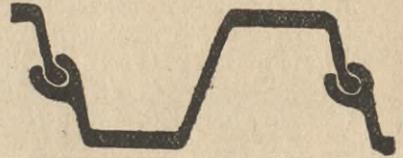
Rothe Erde-Spundwand. [Gelsenkirchener Bergwerks-Aktien-Gesellschaft, Abt. Aachener Hütten-Verein, Aachen-Rothe Erde.]
